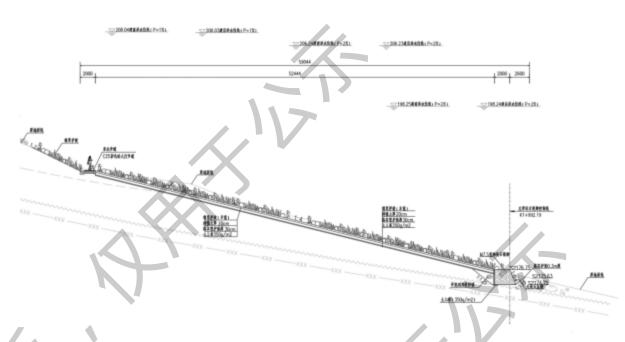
方案三M7.5桨砌块石脚镇脚典型断面示意图
